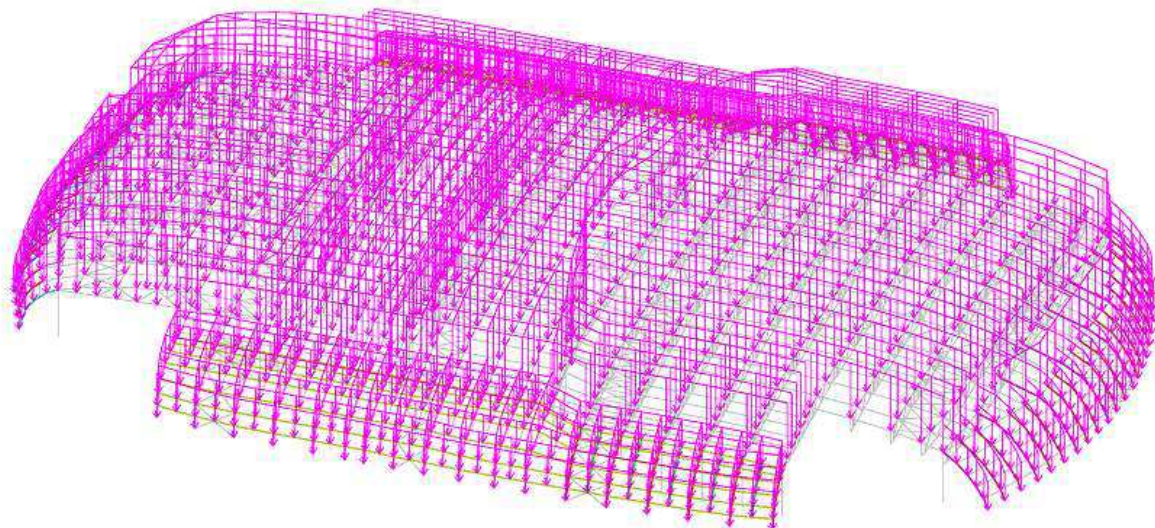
Схема загрузки покрытия снеговой нагрузкой по варианту 1 (загрузка 3)
